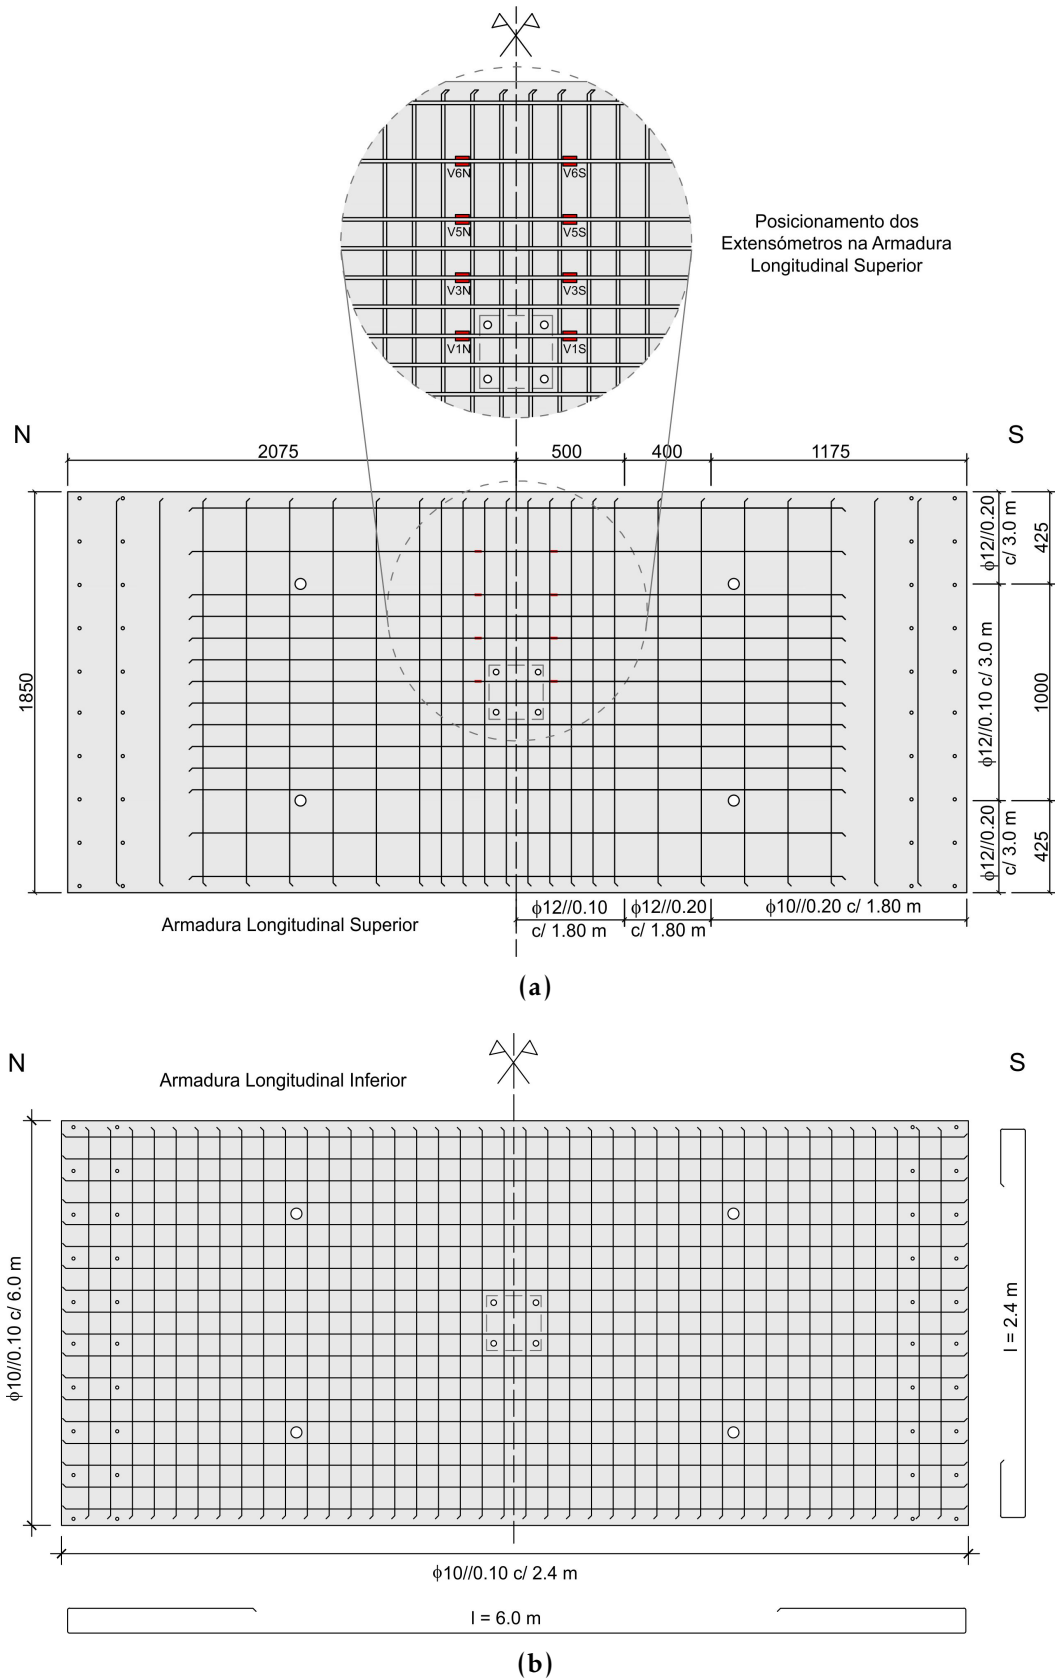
Esquema das armaduras longitudinais dos modelos de laje (desenhos sem escala e dimensões em mm): (a) armadura superior e (b) armadura inferior.
